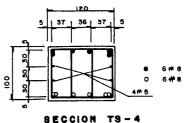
ARMADO DE TRABES DE CONCRETO.
